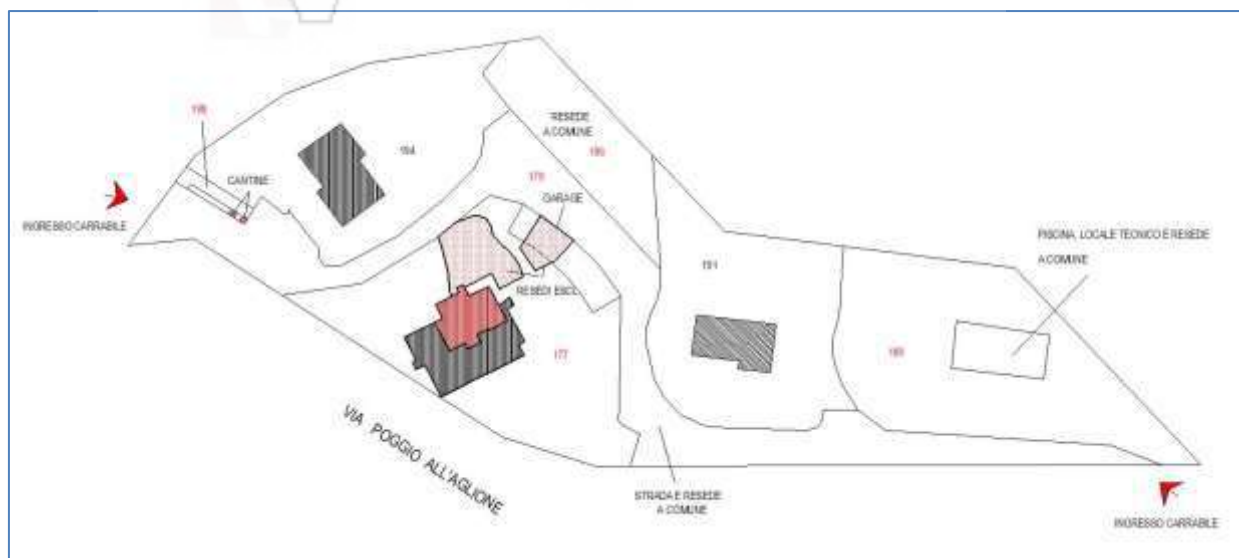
SCHEMA PLANIMETRICO CATASTALE
